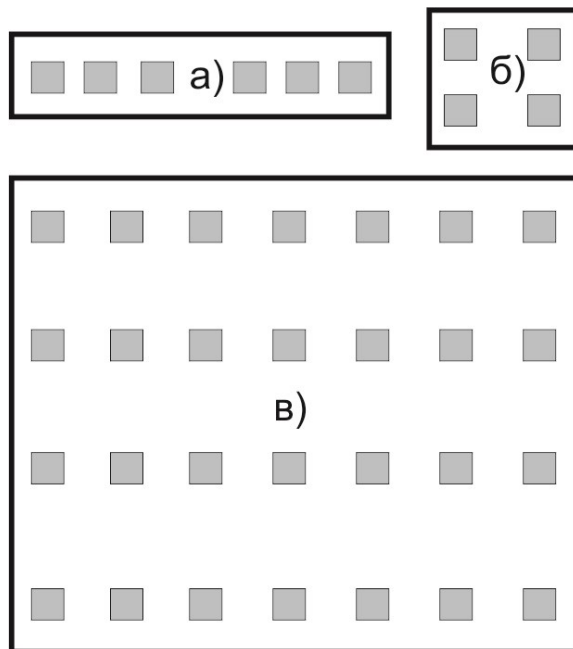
Виды свайных фундаментов: а – ленточный; б – куст; в – поле
